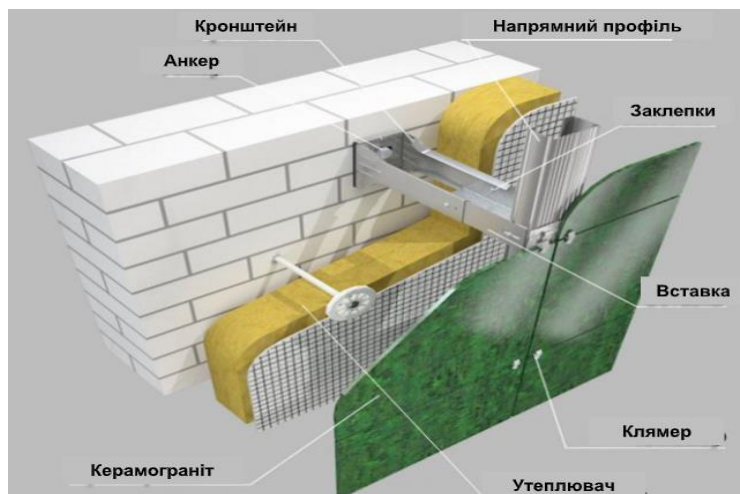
Принципове конструктивне рішення влаштування утеплення методом вентиляваного фасаду.
